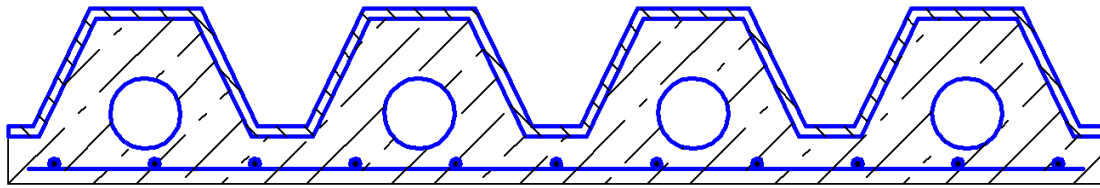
Конструкция кровельной плиты в стадии эксплуатации безрулонной кровли
